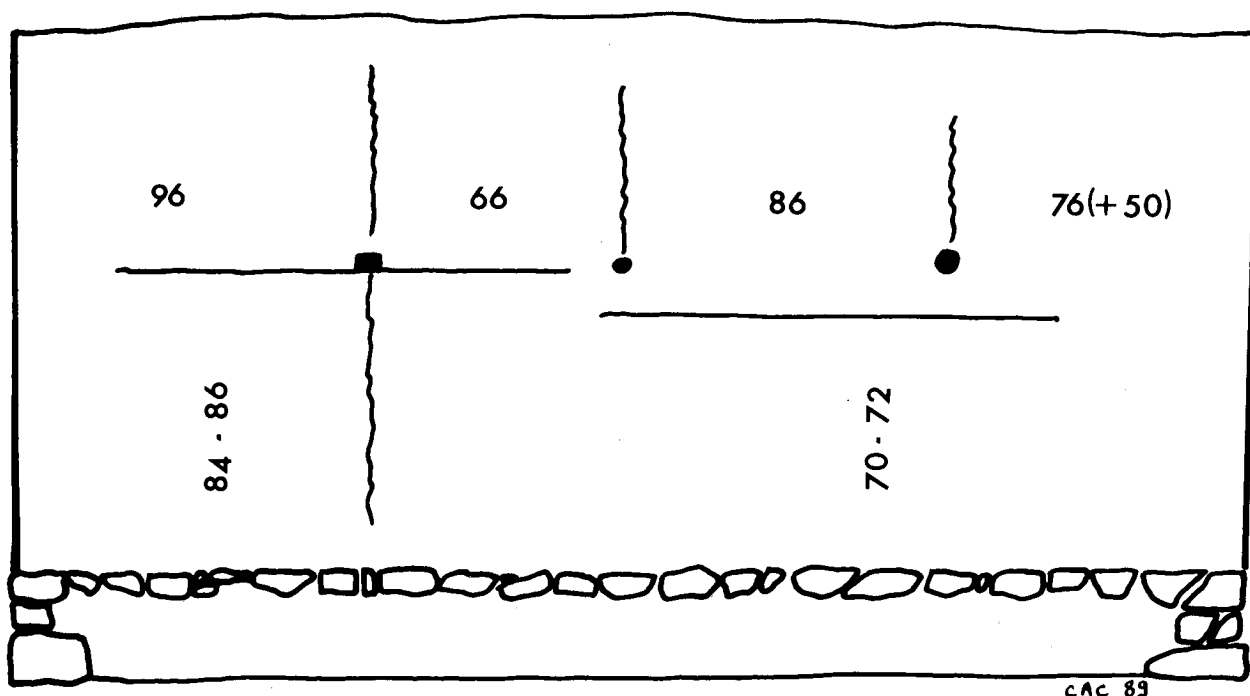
Relevé schématique des joints horizontaux entre les banchées ainsi que des lignes de fissuration visibles sur le parement sud de M14.
